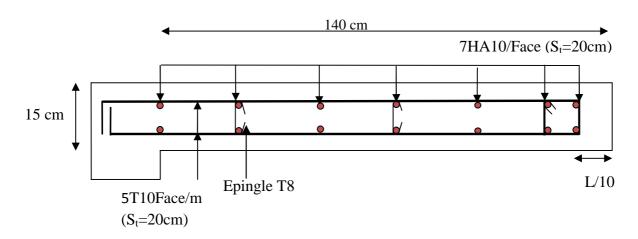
Schéma de ferraillage du voile Vy1 des niveaux 2 à 9
